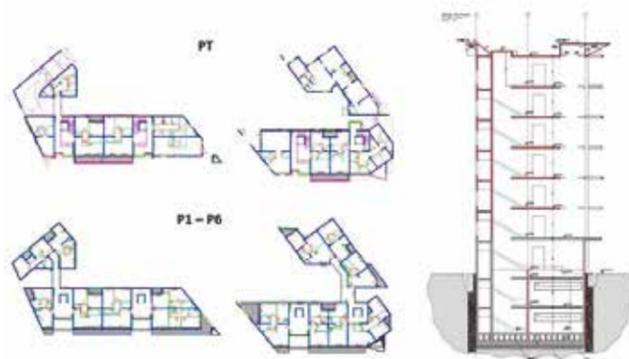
Piante e sezione (Fonte: Casa Spa)
